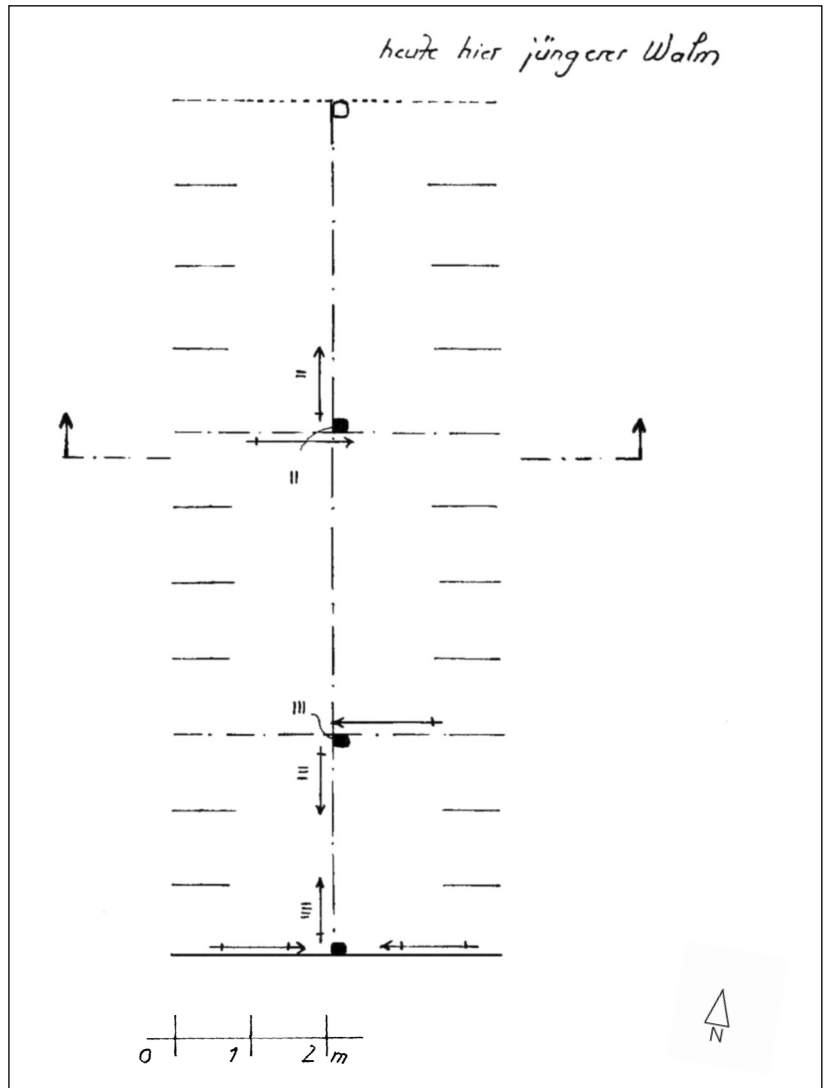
Spitalstraße 26, Grundriss Dachwerk.
